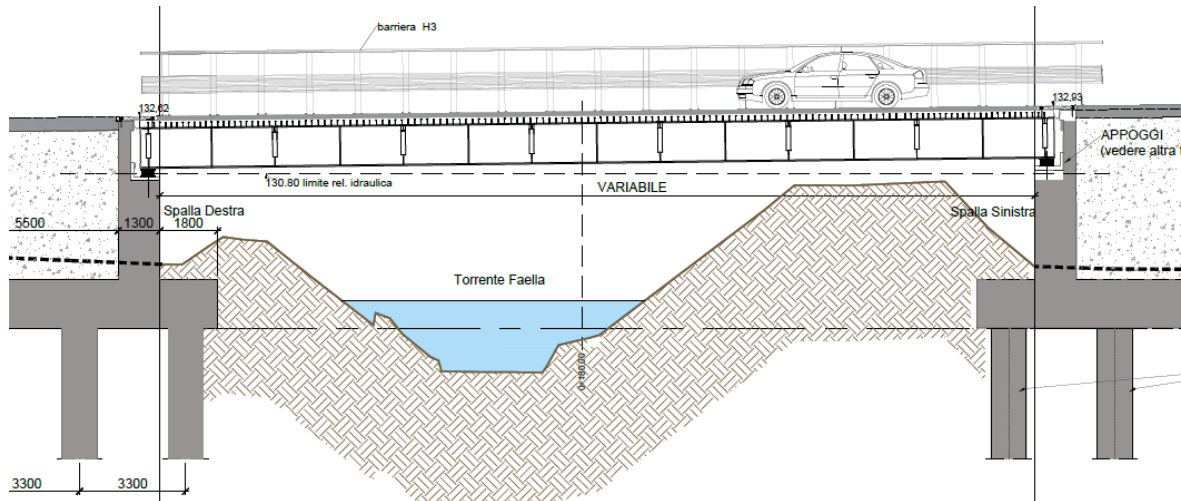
Sezione longitudinale del nuovo ponte sul Torrente Faella.
